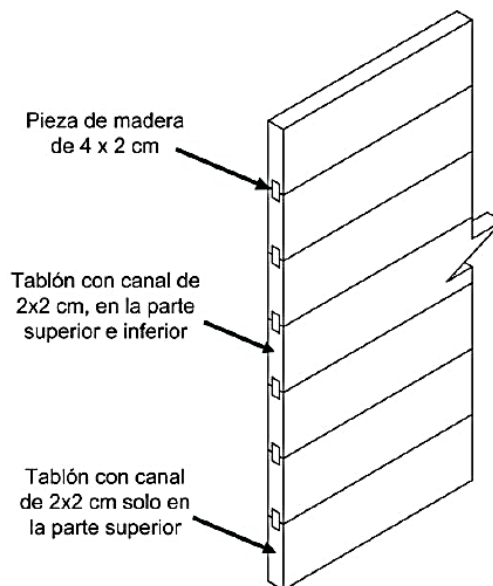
Detalle de los ensamblajes para la construcción de los paneles de madera
